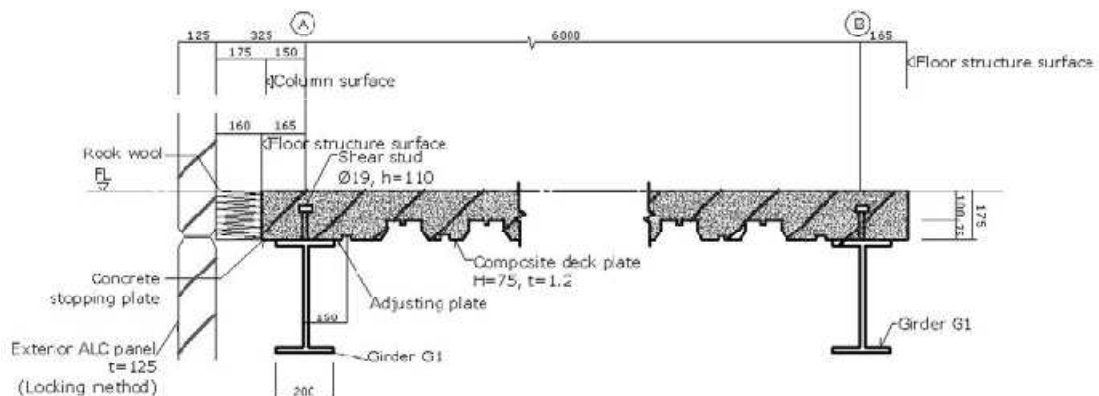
Pormenor da laje do 1º, 2º e 3º pisos
